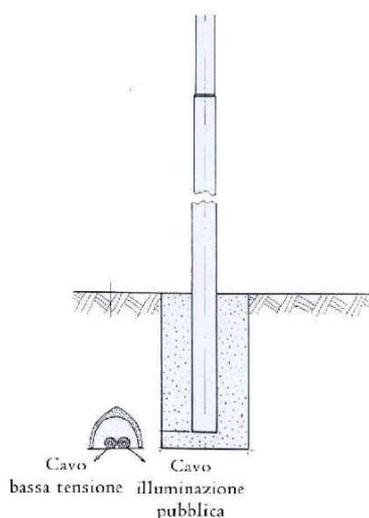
Impianto con linea di alimentazione propria ma sotto la stessa protezione meccanica della rete di bassa tensione.
